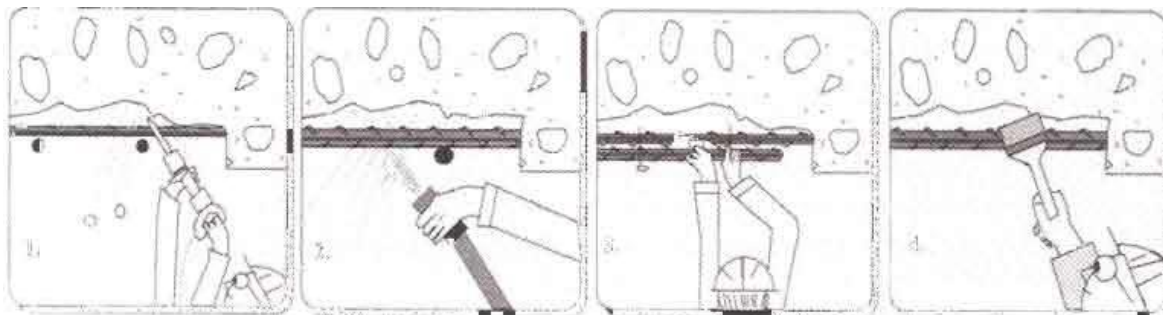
Pripremljena površina betona i armature za nanošenje sloja novog morta
